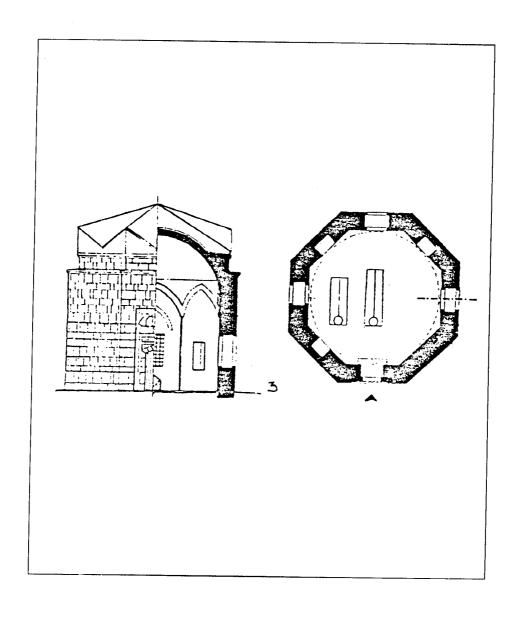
مسقط أفقي لتربة سليم الأول بإستانبول (عن : اصلان ابا) .
